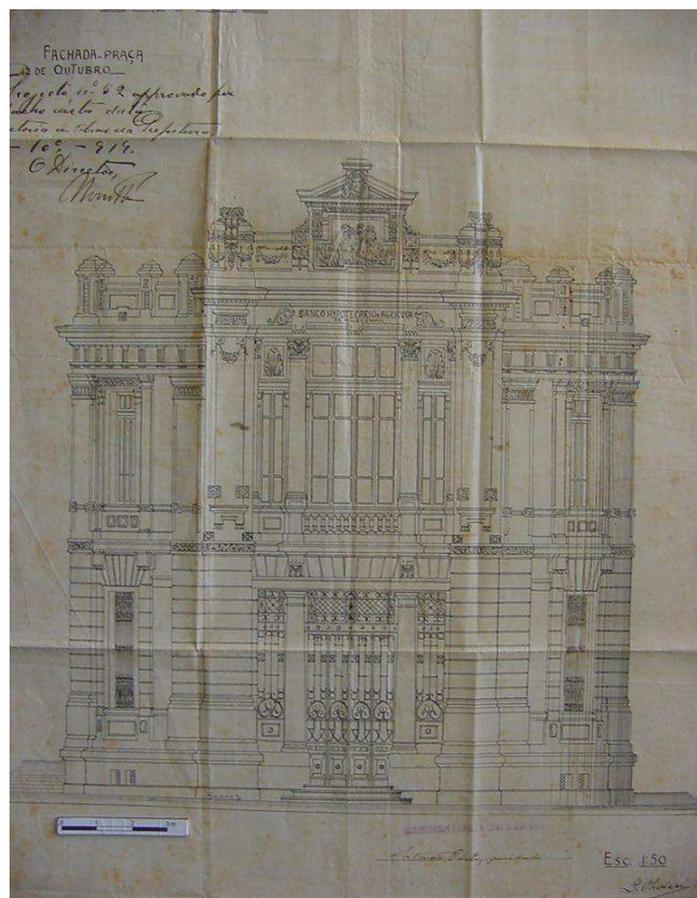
Detalhe do Projeto de Luiz Olivieri referente à construção situada onde hoje é a Praça 7, no ano de 1919. Lote ?, Quadra 14, Seção 02. Acervo: APCBH. Foto: NORONHA, Carlos Roberto. Pesquisa de projetos de arquitetura na área central de Belo Horizonte.
